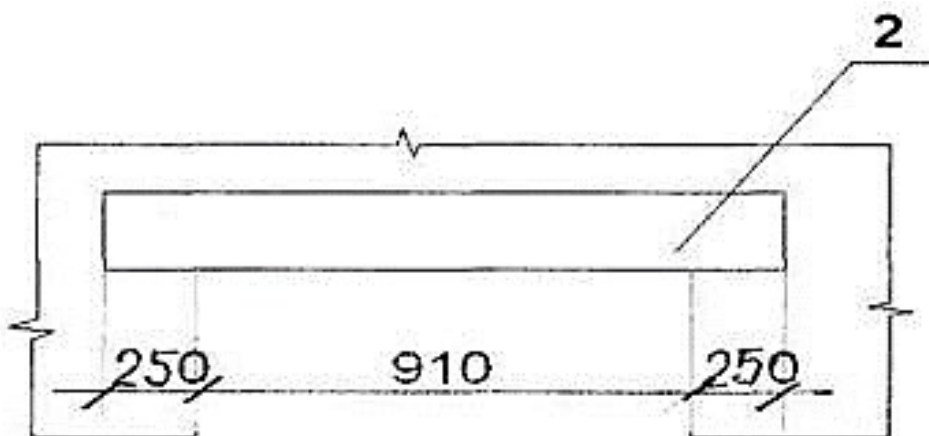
Схема опирания несущей перемычки над проёмом
